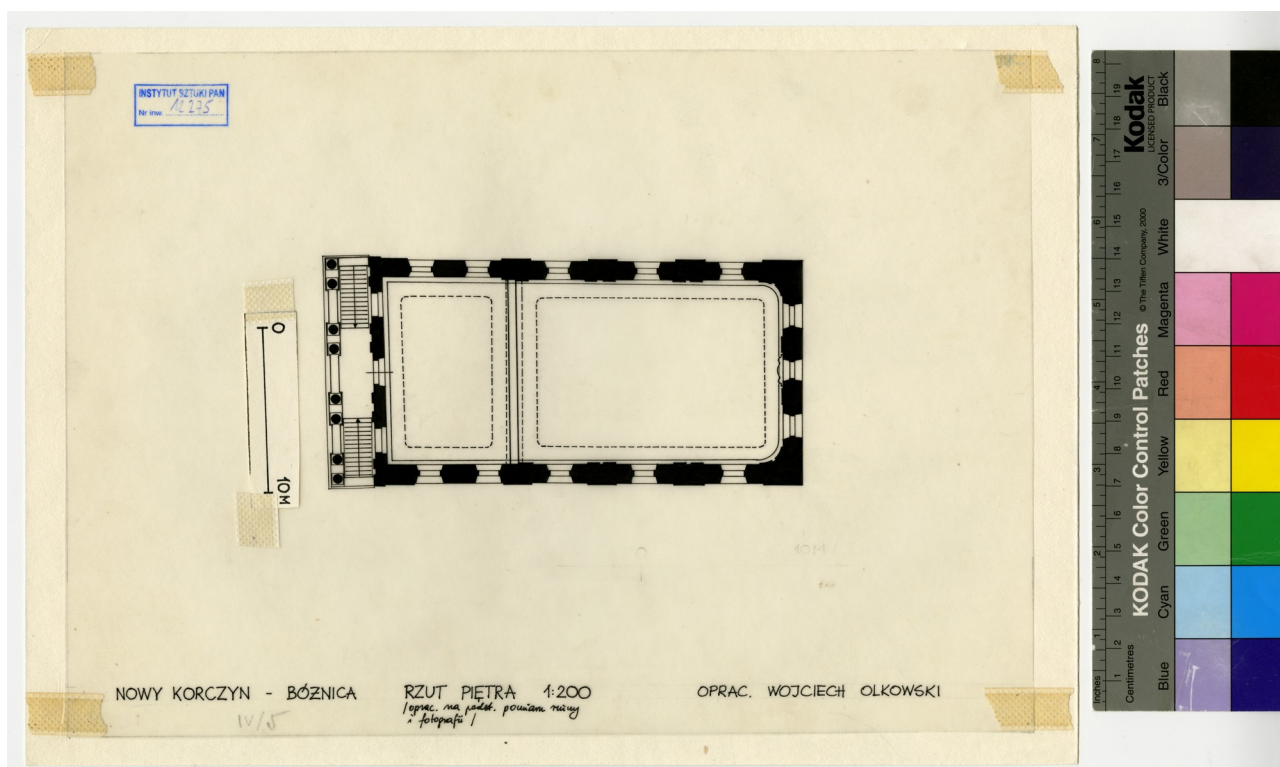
Grundriss 1. Obergeschoss 1987
